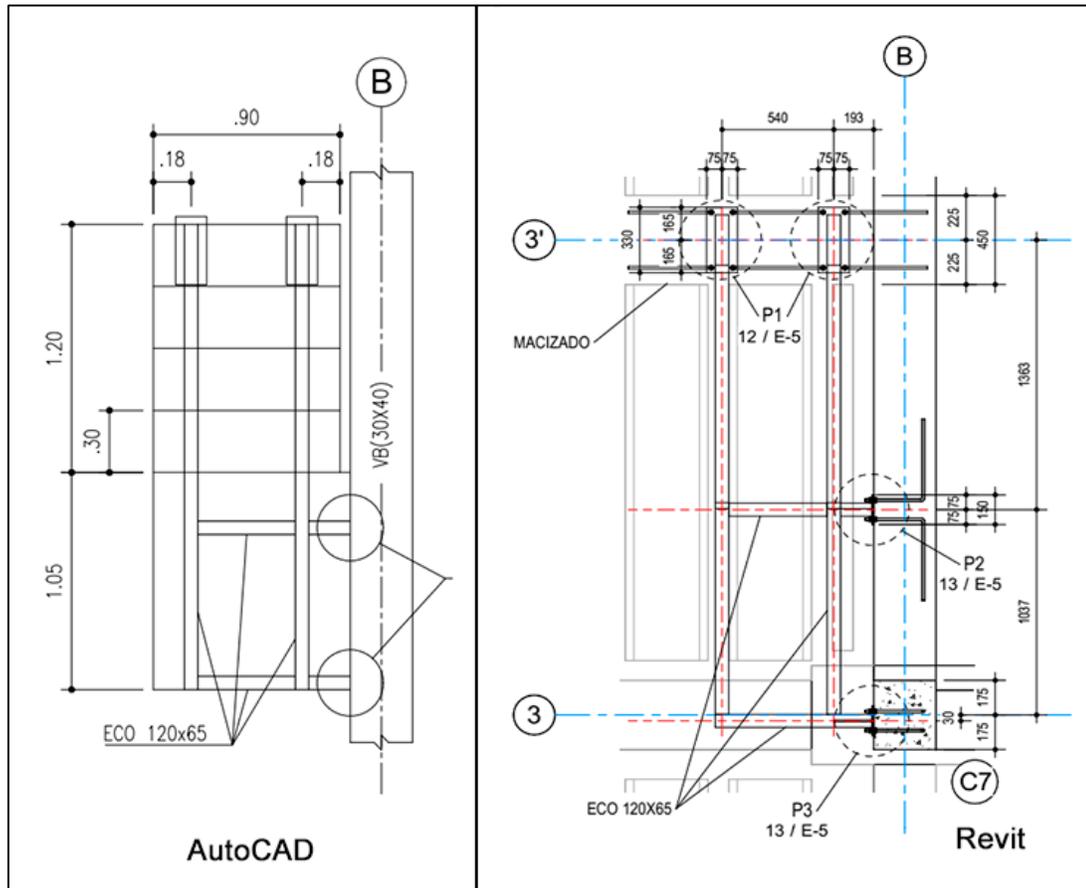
Escalera de PT1 a PSM en CAD y BIM
